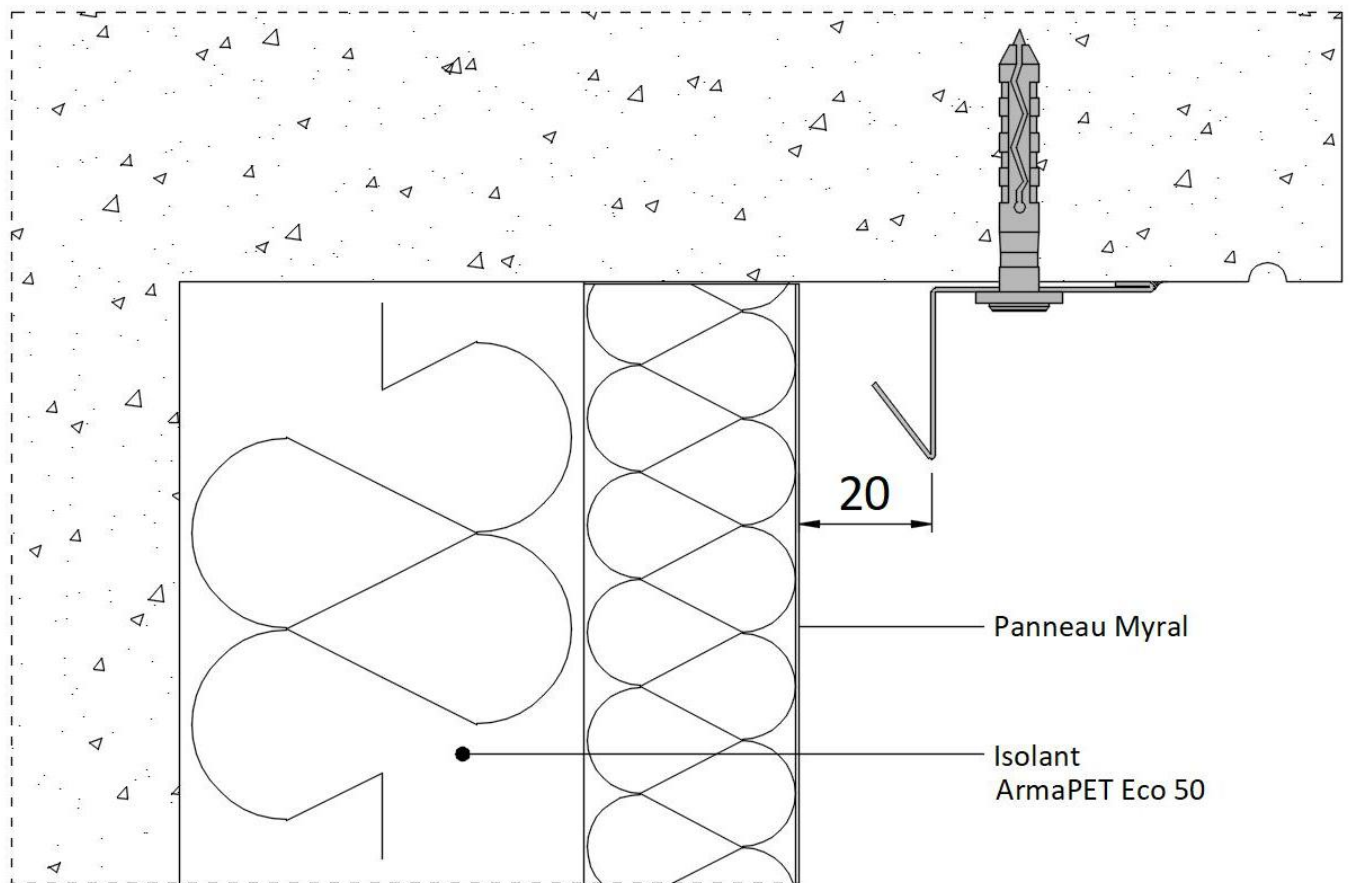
Haut de façade avec nez de dalle saillant – (coupe verticale)
